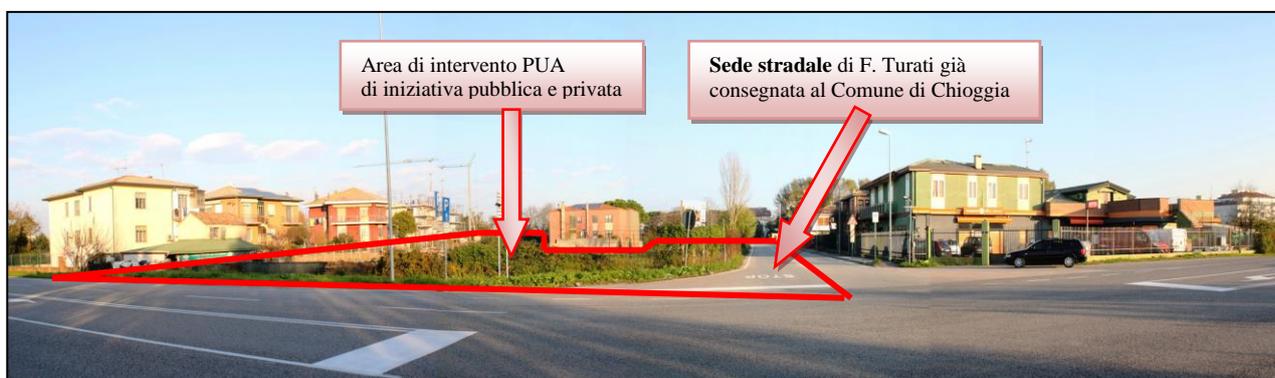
Vista dell'area del PUA dalla strada Maestri del Lavoro
